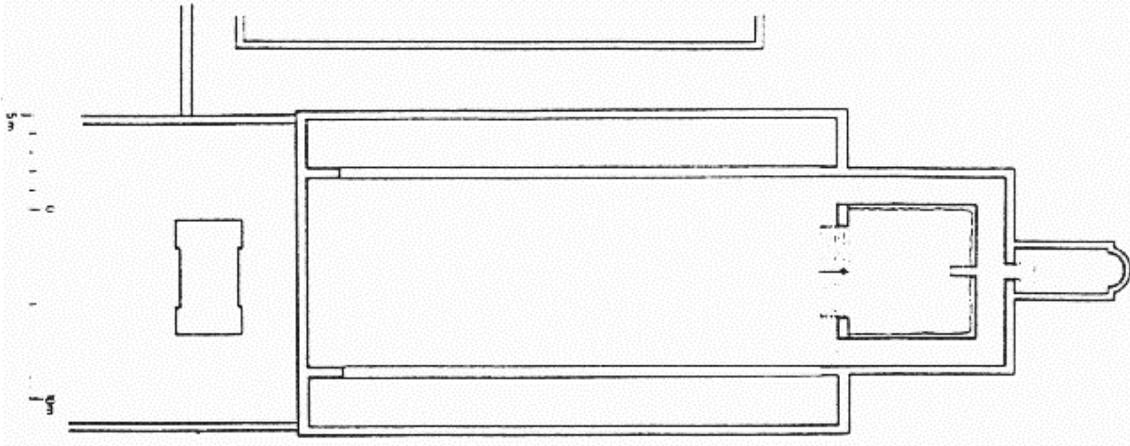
Grundrißrekonstruktion der Gründungsanlage nach Esterhues.
